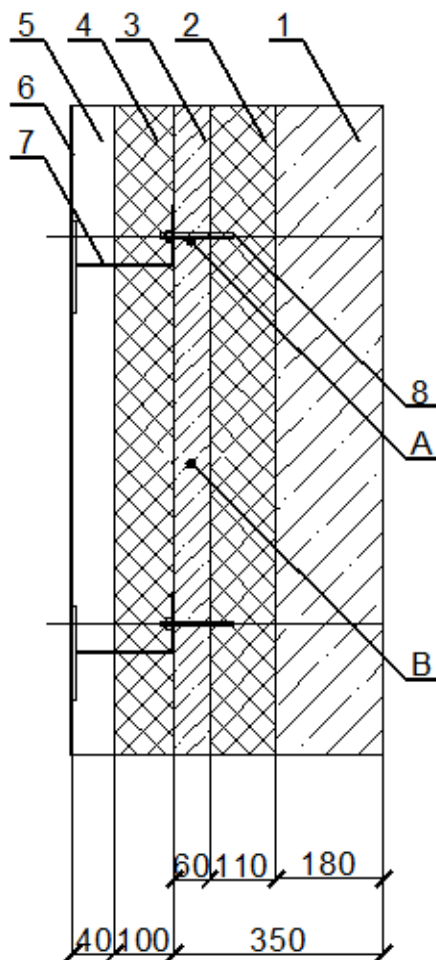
Конструкция сборной трехслойной железобетонной панели с навесным вентилируемым фасадом. 1- Несущий слой из керамзитобетона; 2- Внутренний теплоизоляционный слой; 3-Защитный слой из бетона; 4- Теплоизоляционный материал НВФ; 5-Воздушный зазор; 6- Облицовочный слой НВФ; 7-Кронштейн крепления НВФ; 8-Анкер крепления НВФ; А- расчётная точка в середине защитного слоя, на поверхности, соприкасающейся с материалом анкера; В-расчётная точка в середине защитного слоя находящаяся вне зоны влияния анкера крепления НВФ
